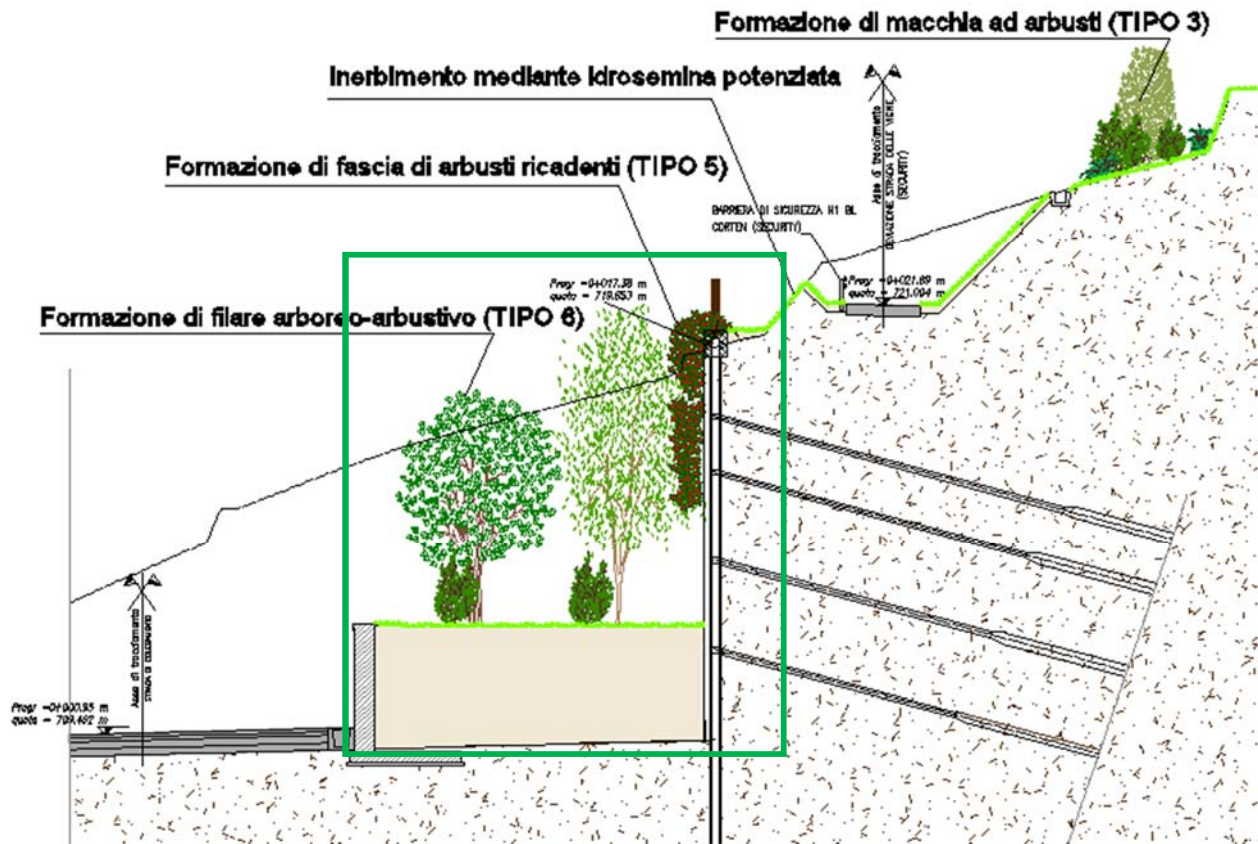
Mascheramento muri con piantumazione di specie ricadenti
